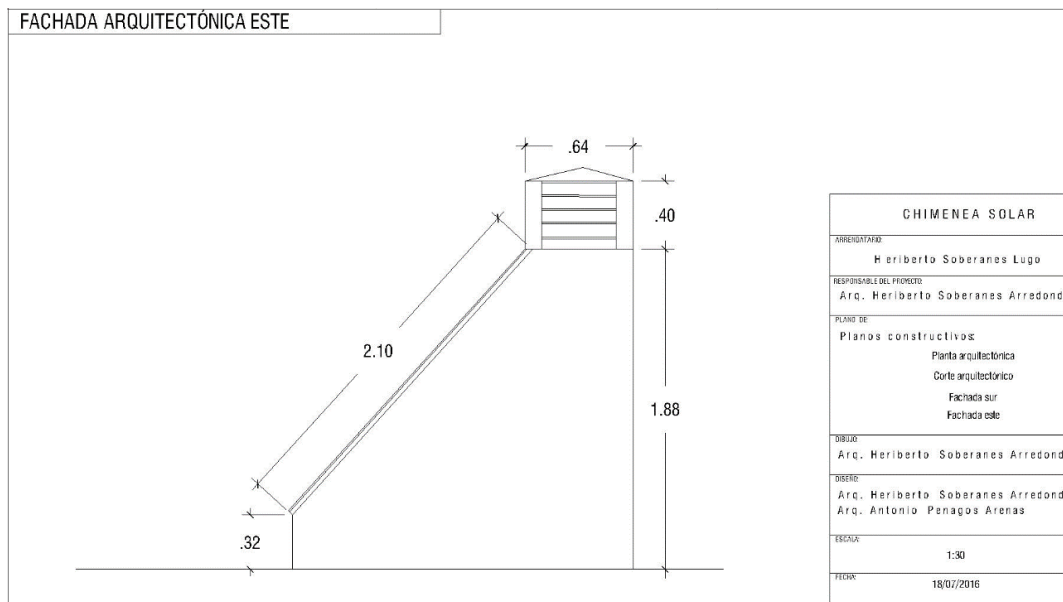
Plano de fachada arquitectónica este de chimenea solar. Fuente: propia
